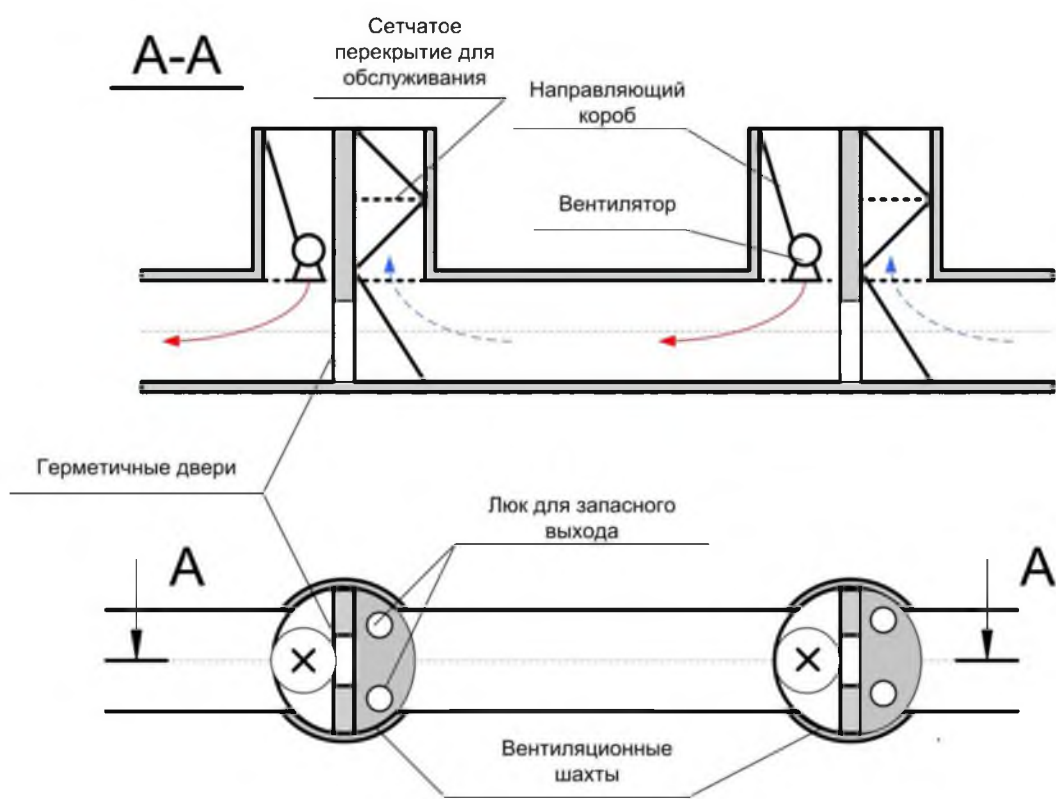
Вариант схемы вентиляции коммуникационного коллектора с круглой формой поперечного сечения вентшахт
